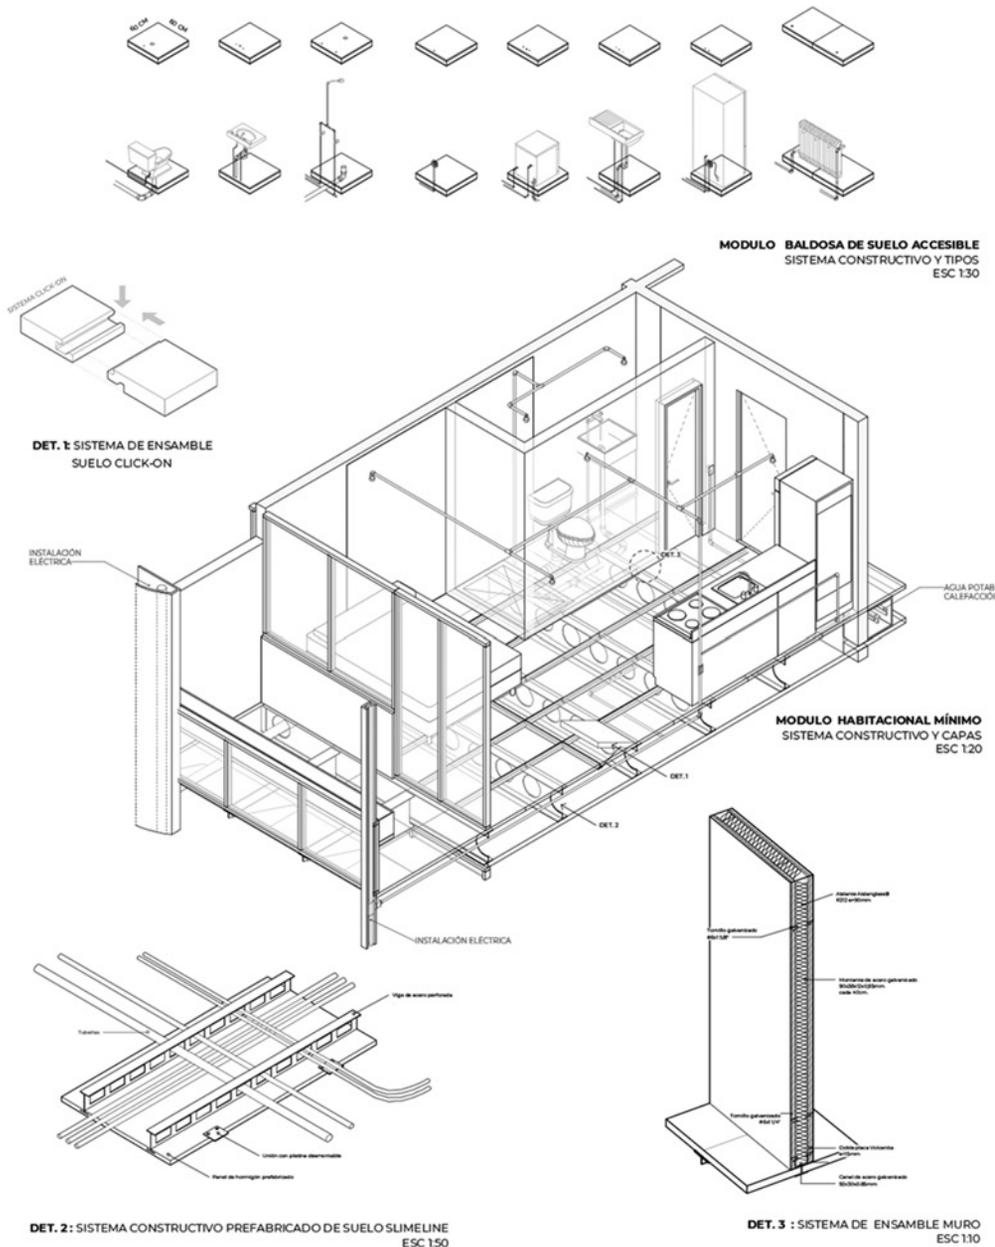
Detalles constructivos de instalaciones accesibles y paneles móviles. Fuente: elaboración propia.
